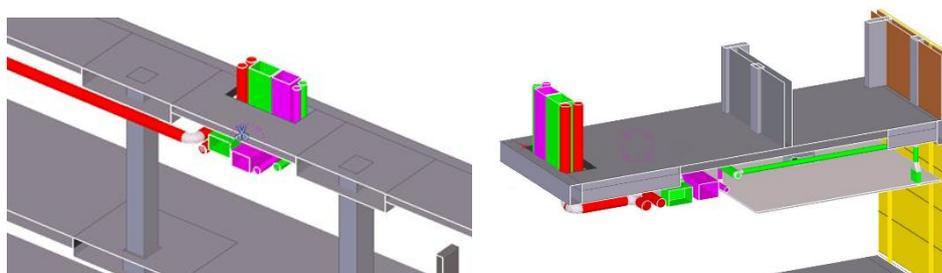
Compatibilização entre piso de betão e rede de AVAC
